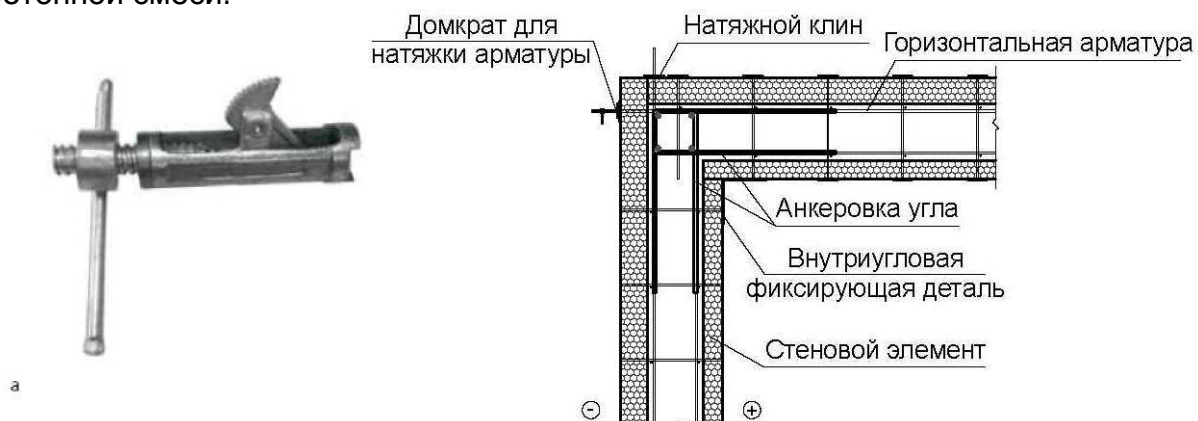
Натяжка арматуры стены: а - ручной домкрат для натяжки арматуры; б - способ натяжки угла стены.
